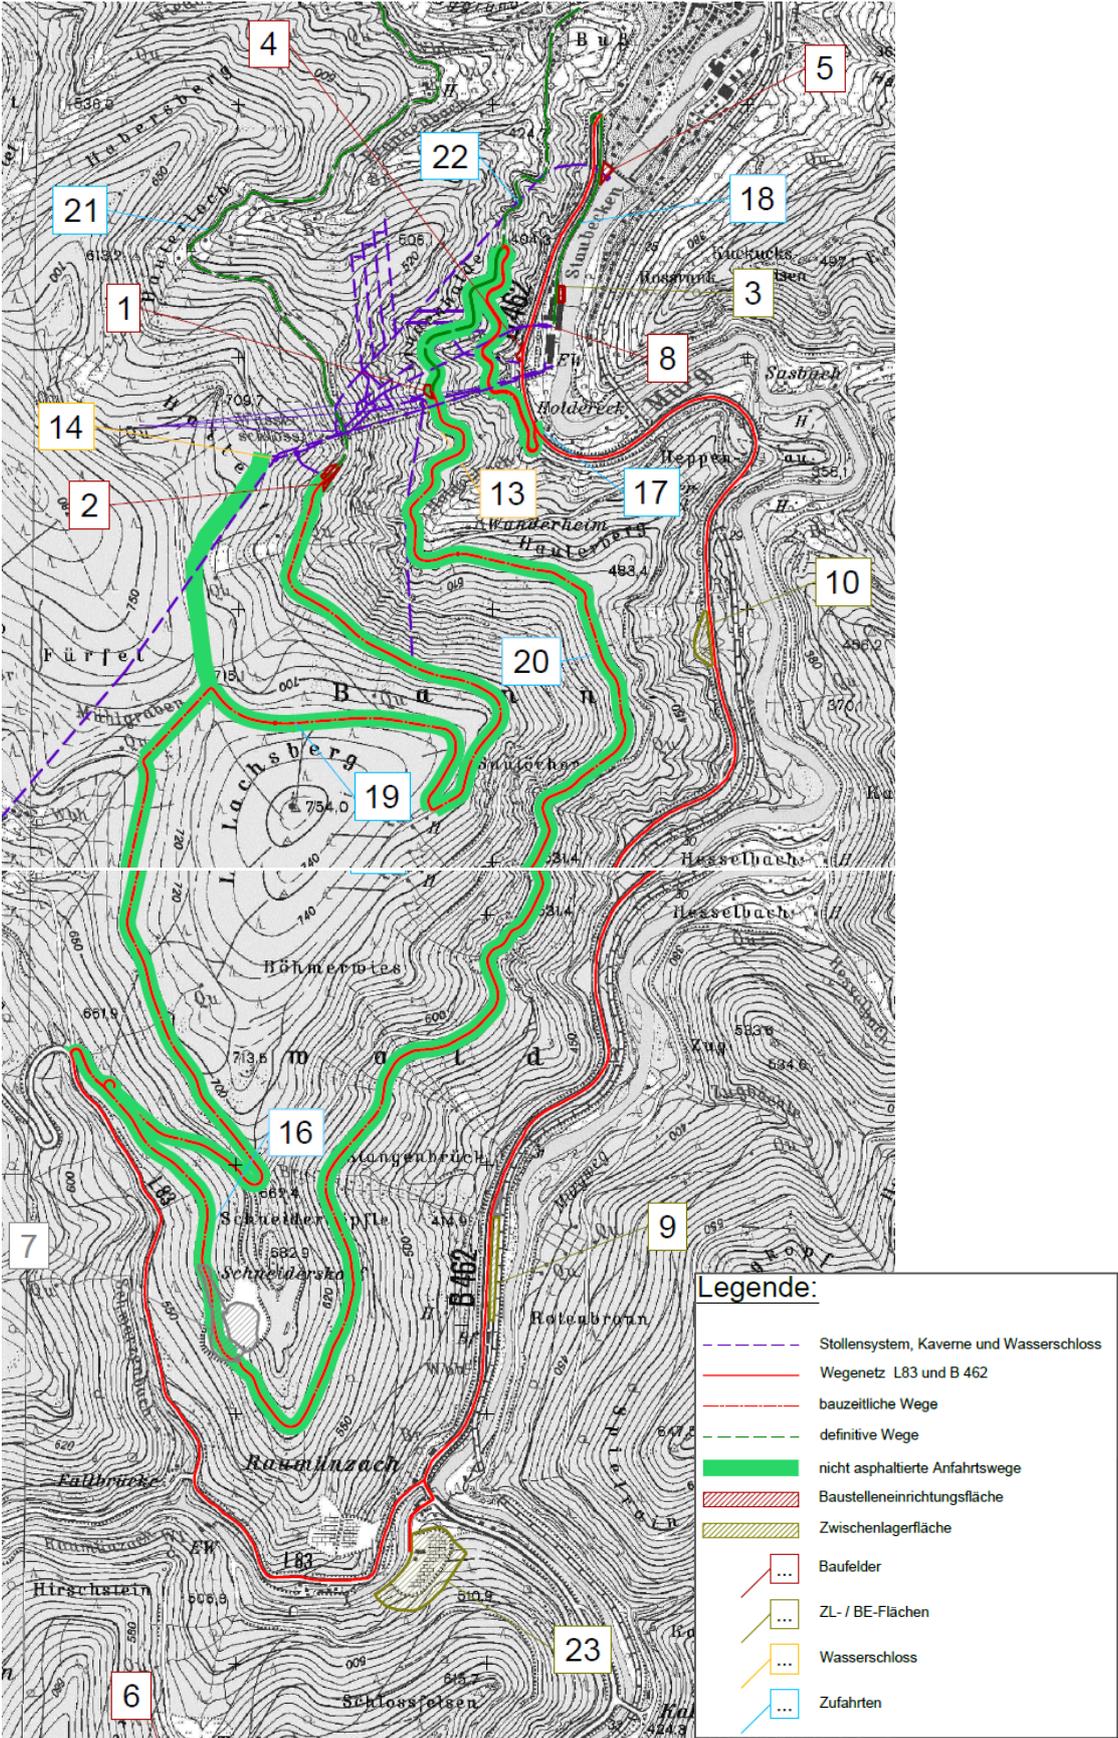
Unterstufe, Lageplan der einzelnen Baufelder.
